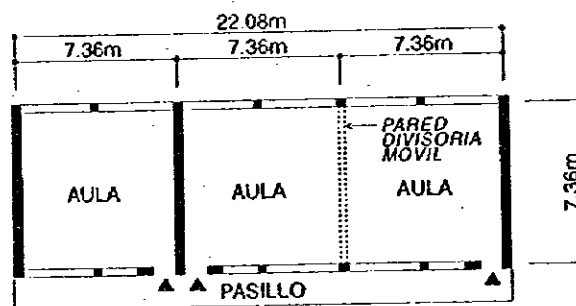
Plan superficial de edificio de tipo tres aulas
